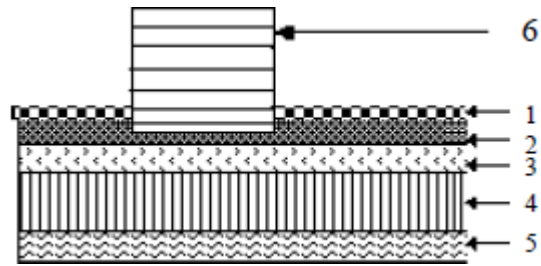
Coupe verticale d'un plancher étage courant - corps creux-
